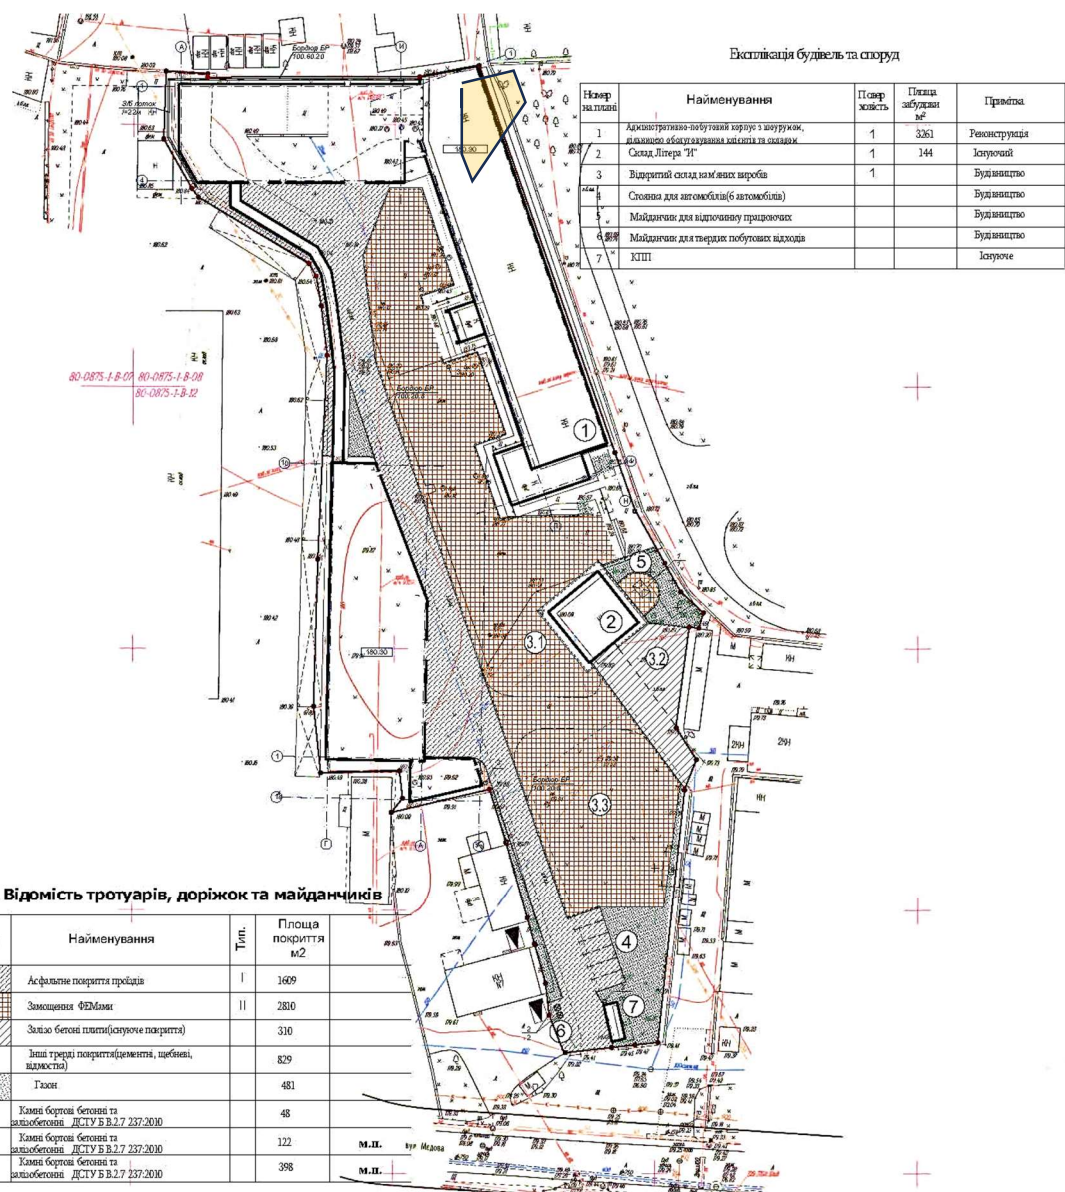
Фрагмент генерального плану - схема благоустрою території
